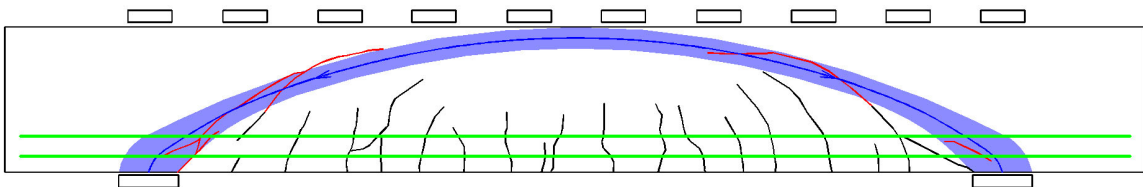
Balken BO 1 mit überlagerter Druckparabel und zugehörigen Rissen
